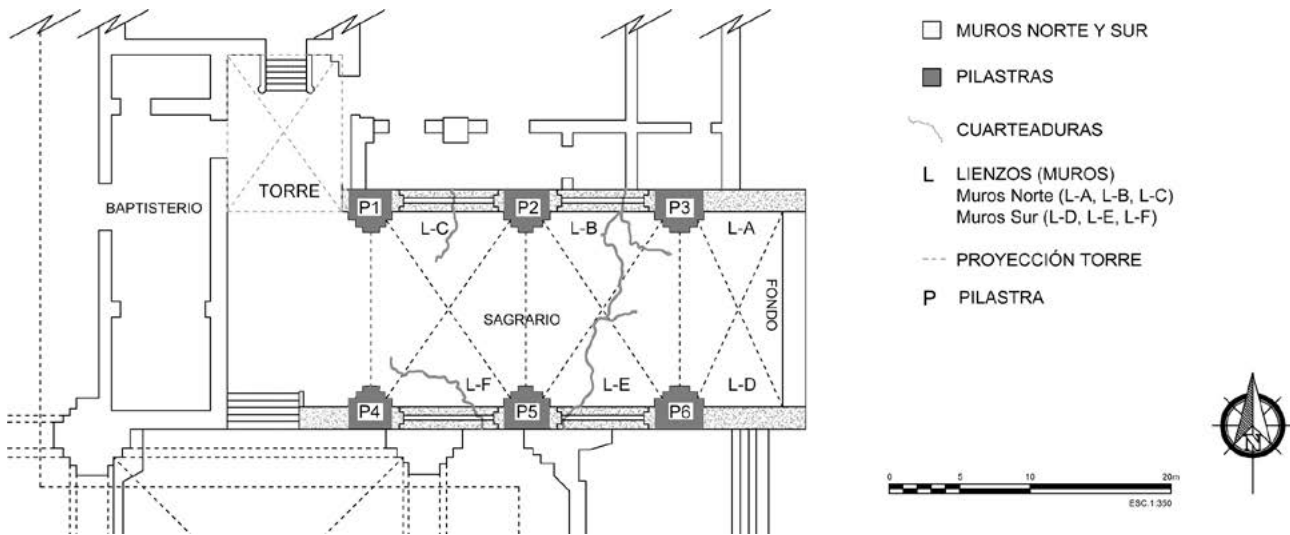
Lienzos, pilastras y fisuras. Dibujo del arquitecto Julio Alberto Rubio García.
